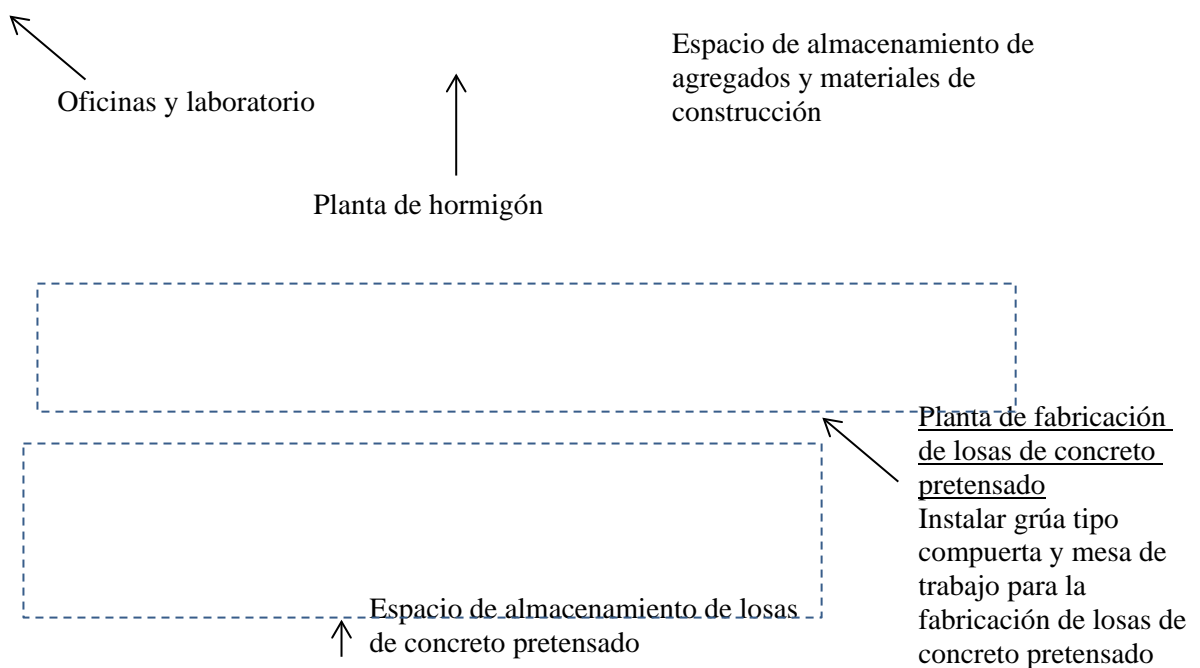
Esquema de la planta de fabricación de losas de concreto pretensado en Lisawe
